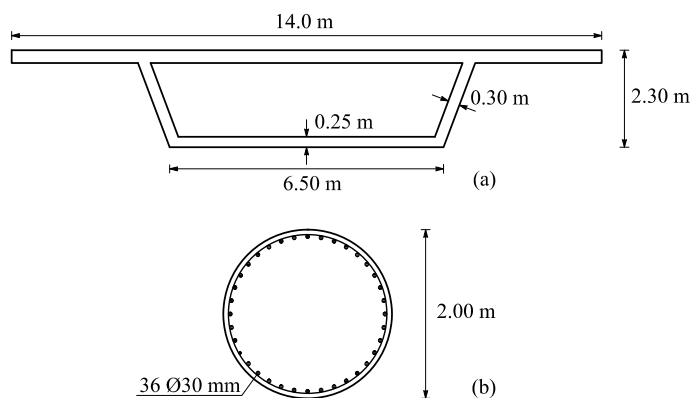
(a) Cross-section of the bridge deck. (b) Cross-section of the bridge piers, with reinforcement layout / (a) Sezione dell'impalcato. (b) Sezione delle pile, con indicazione della disposizione delle armature.
